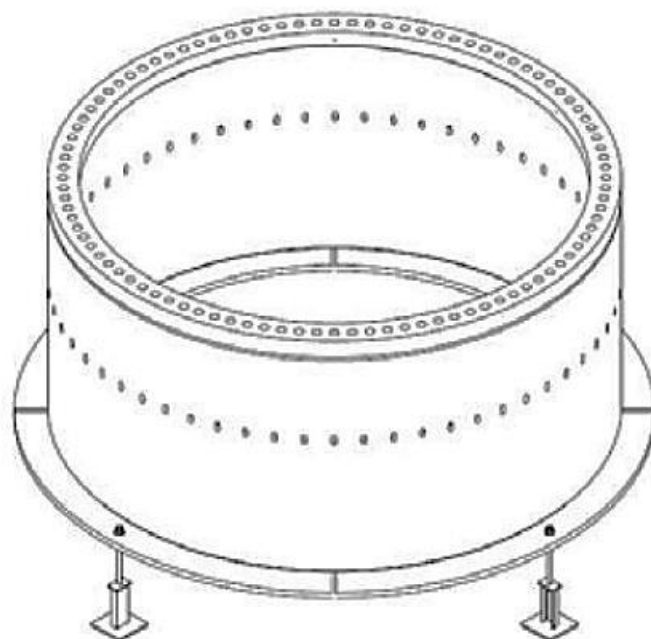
Anel de aço de conexão da torre na fundação – obra em execução.
